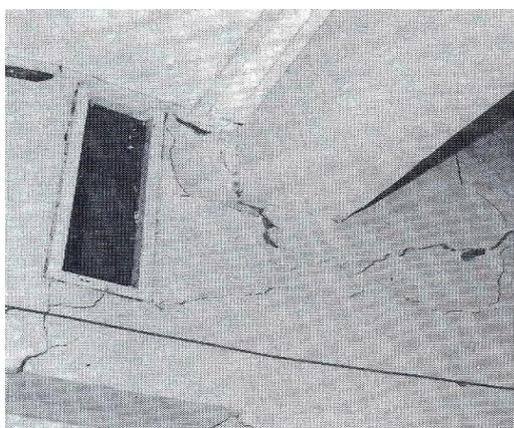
Разрушение кирпичной стены админ. здания (объект №3).
